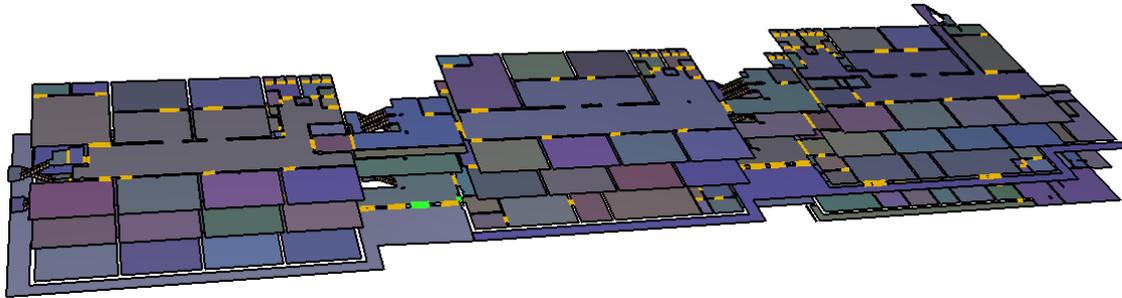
Estrazione dei pavimenti, delle porte e delle scale
